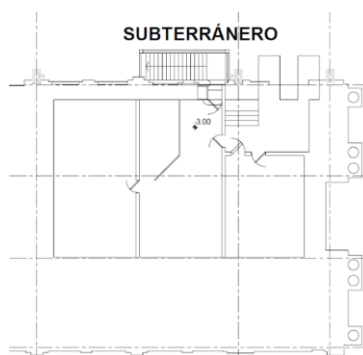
Planta subterráneo Edificio Lateral Oriente.
